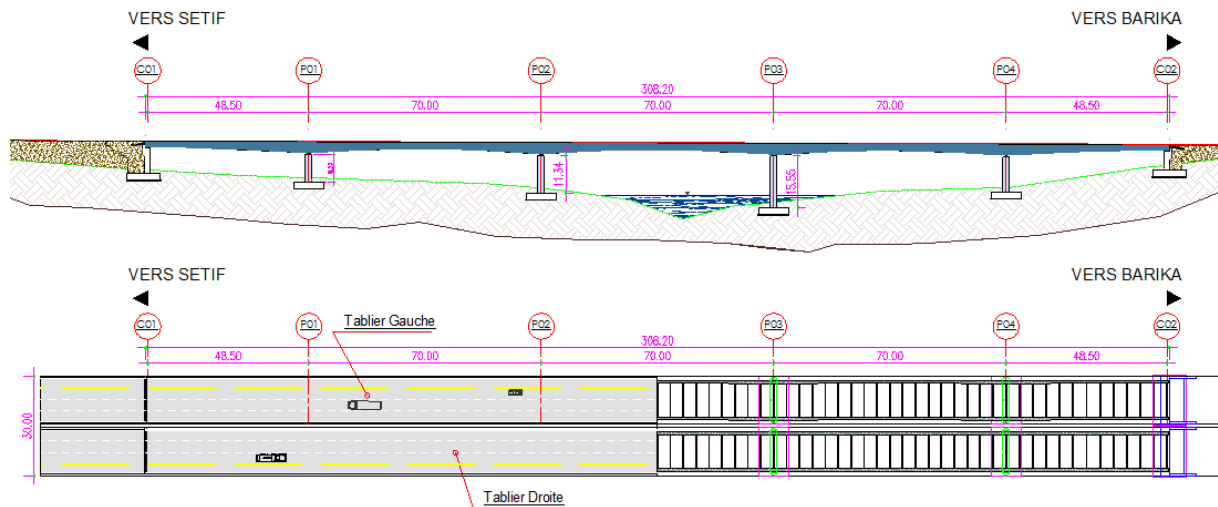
Coupe longitudinale et vue en plan de la Variante 3
